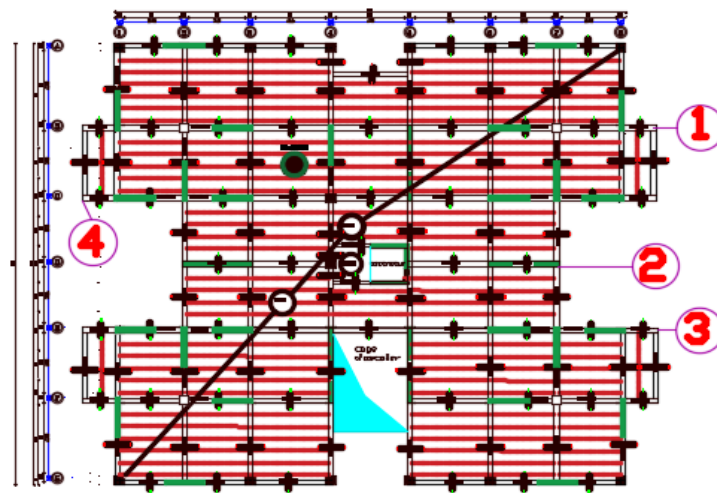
Plan de coffrage précise les 4 cas de poutrelles à étudié
